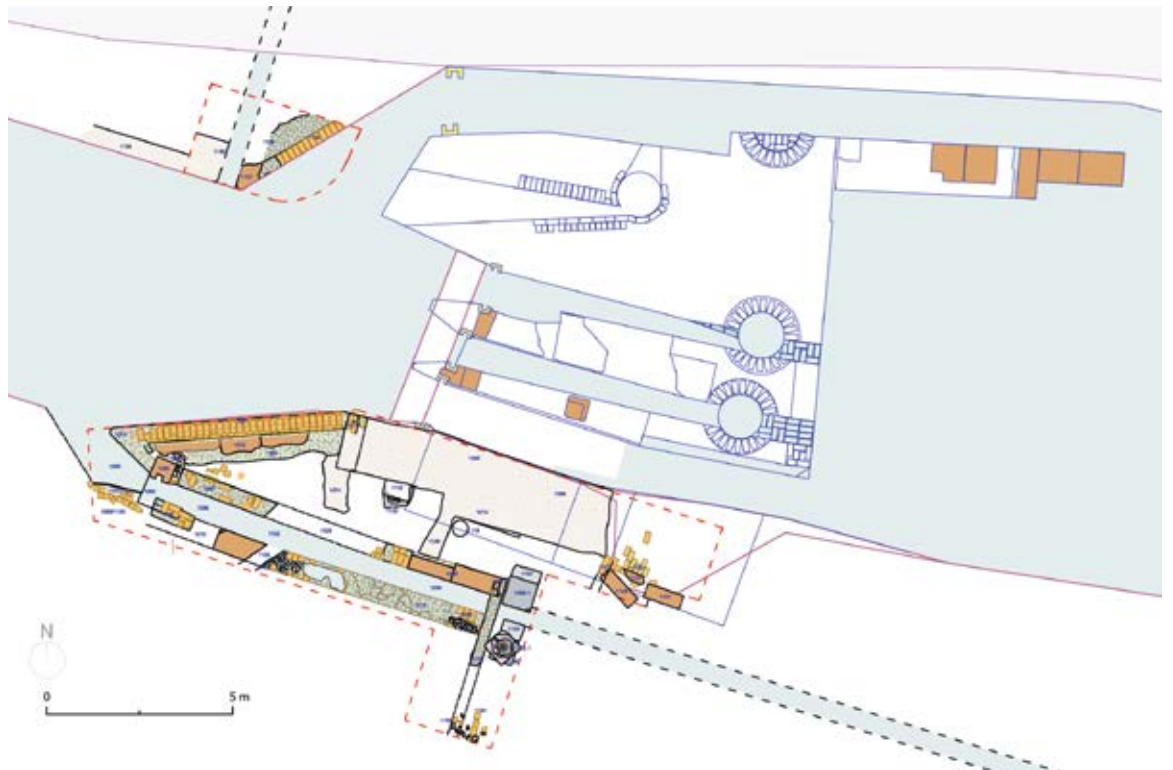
Planta excavación tajamar y canal con sala de pica en el margen derecho de la acequia mayor Aljufía.
